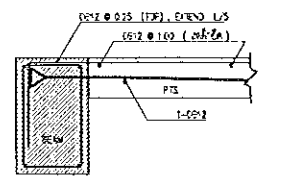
การเสริมเหล็กบริเวณ ANCHORAGE และ DEAD END
